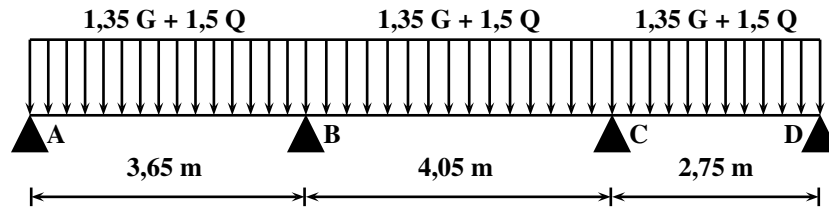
Poutrelle type 2 - cas 1 (ELU)
